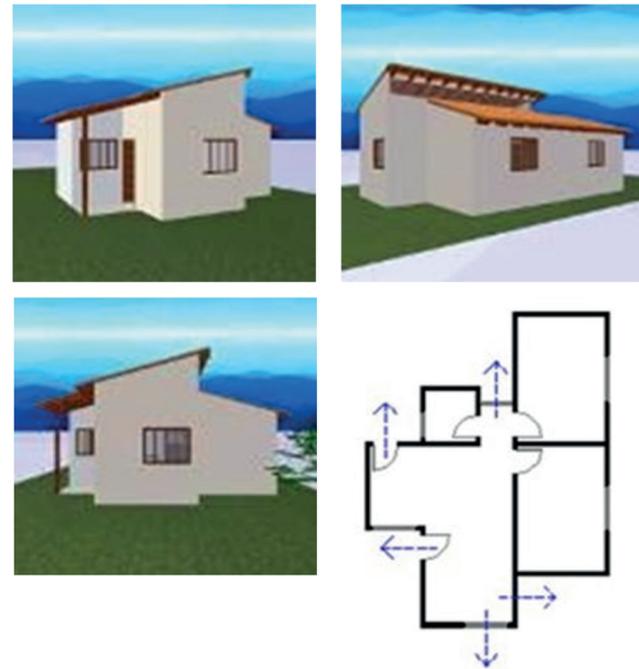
Protótipo I: vistas e planta baixa indicando sentidos de expansão.
